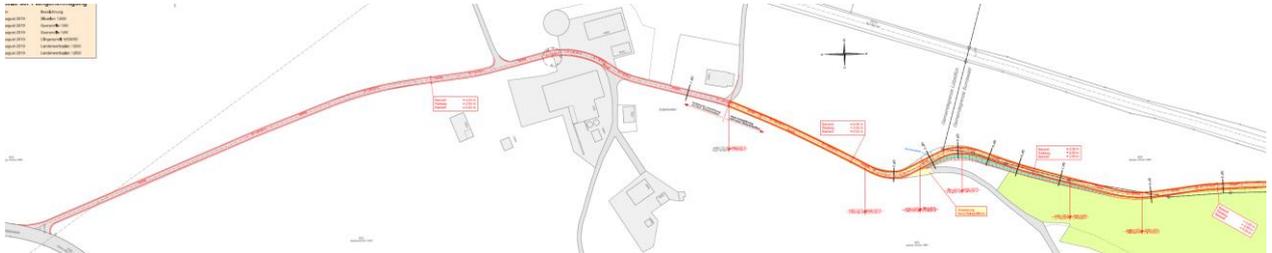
Projektperimeter Strassenplan Abschnitt 1
